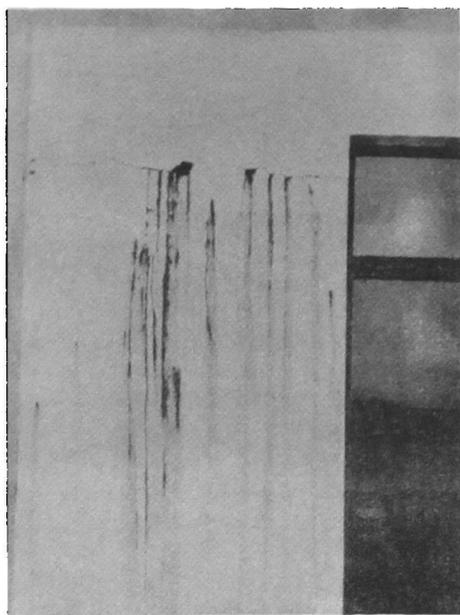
Junta de hormigonado. Hospital Traumatológico de Valdivia.
